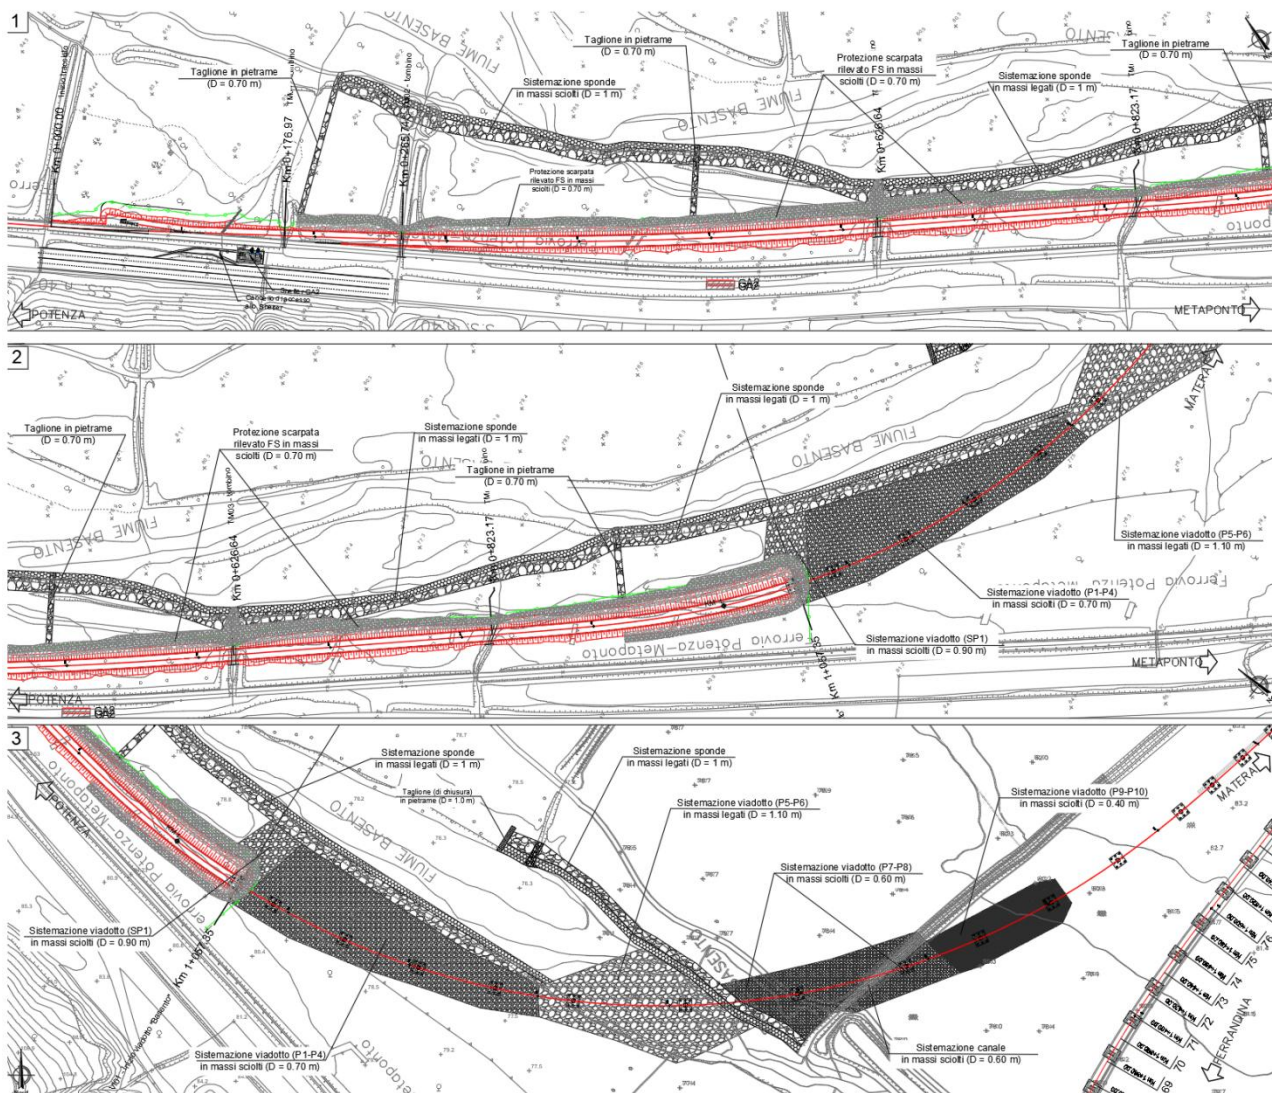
Fiume Basento: estratto della planimetria delle opere di sistemazione e protezione previste.
